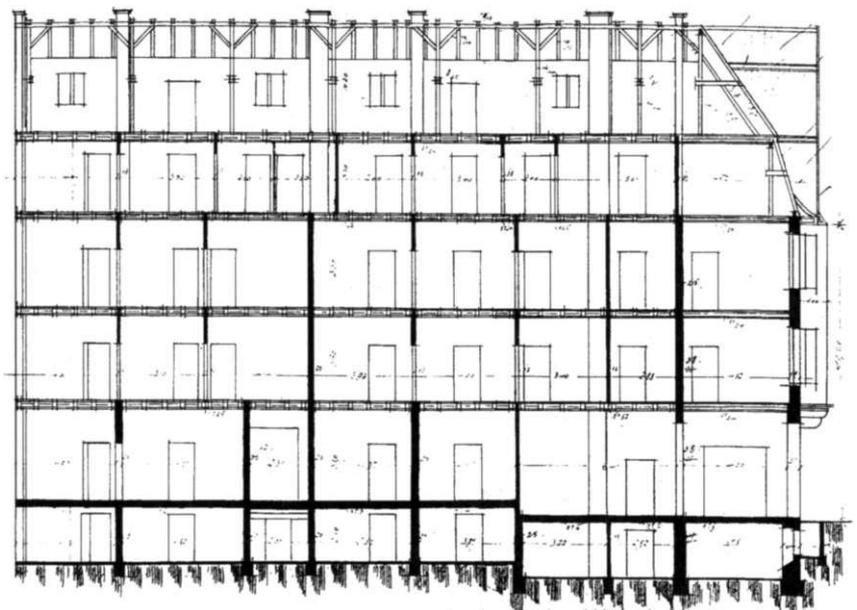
Schellheimerplatz 9, Längsschnitt durch das Wohnhaus mit eingezeichneten Holzbalkendecken.
